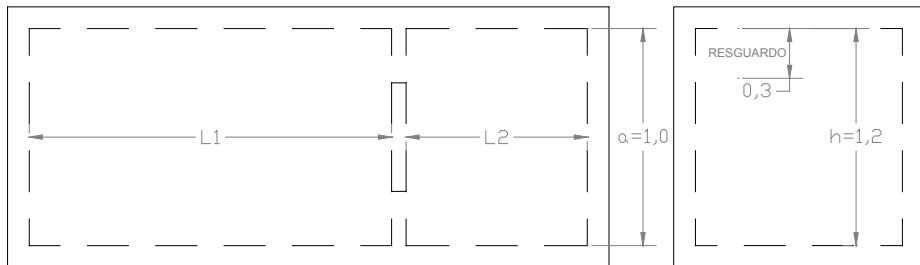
Seccións en planta e alzado dunha fosa séptica (cotas en metros)
